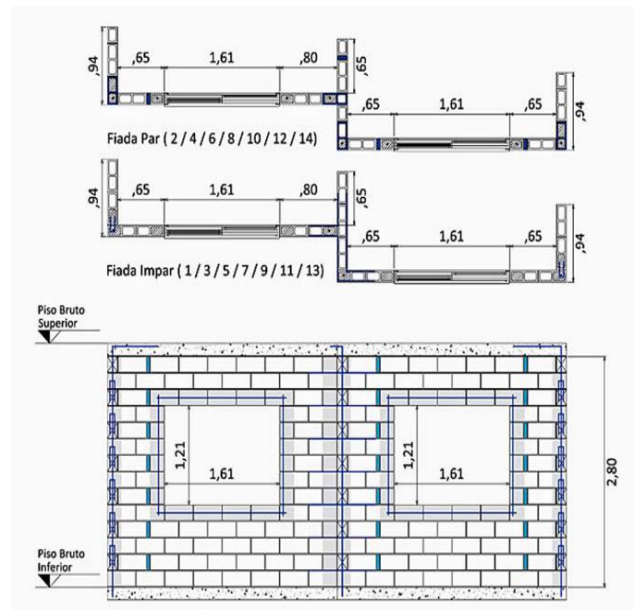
Alvenaria estrutural armada ou parcialmente armada.
